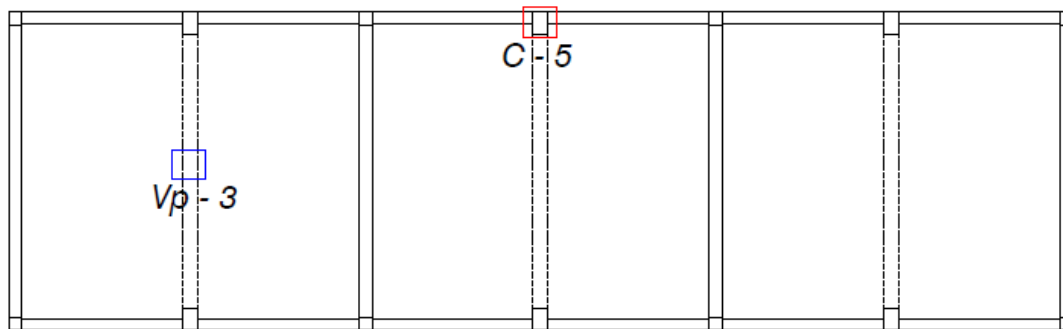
Ubicación de ensayo de Esclerómetro en el pabellón 4 – 2do piso
